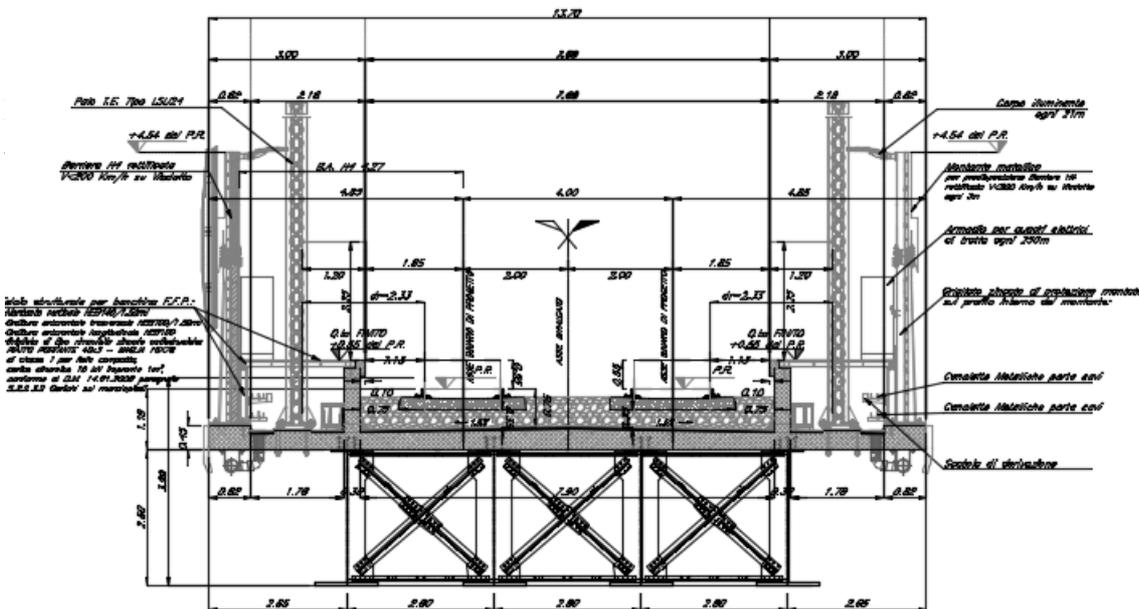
Viadotto Satano: sezione trasversale e prospetto binario pari
